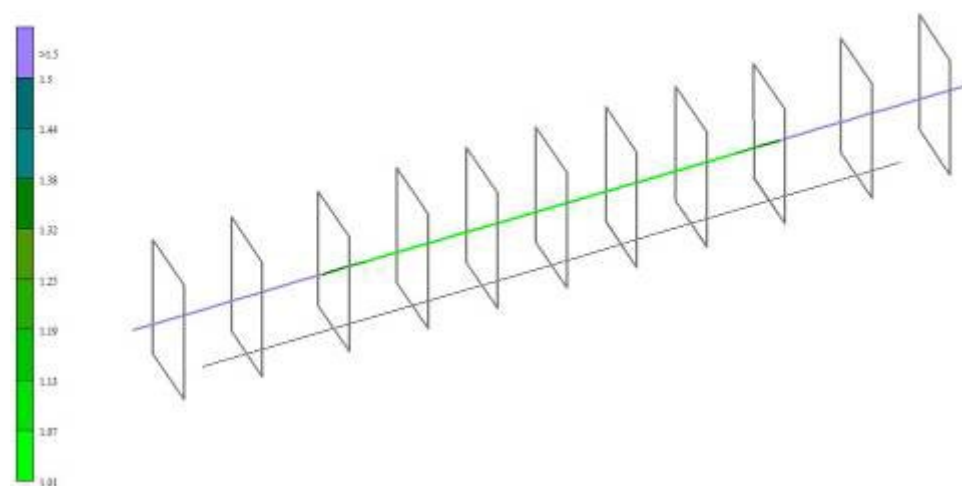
Коэффициент запаса армирования балки с усилением по всей расчетной длине
